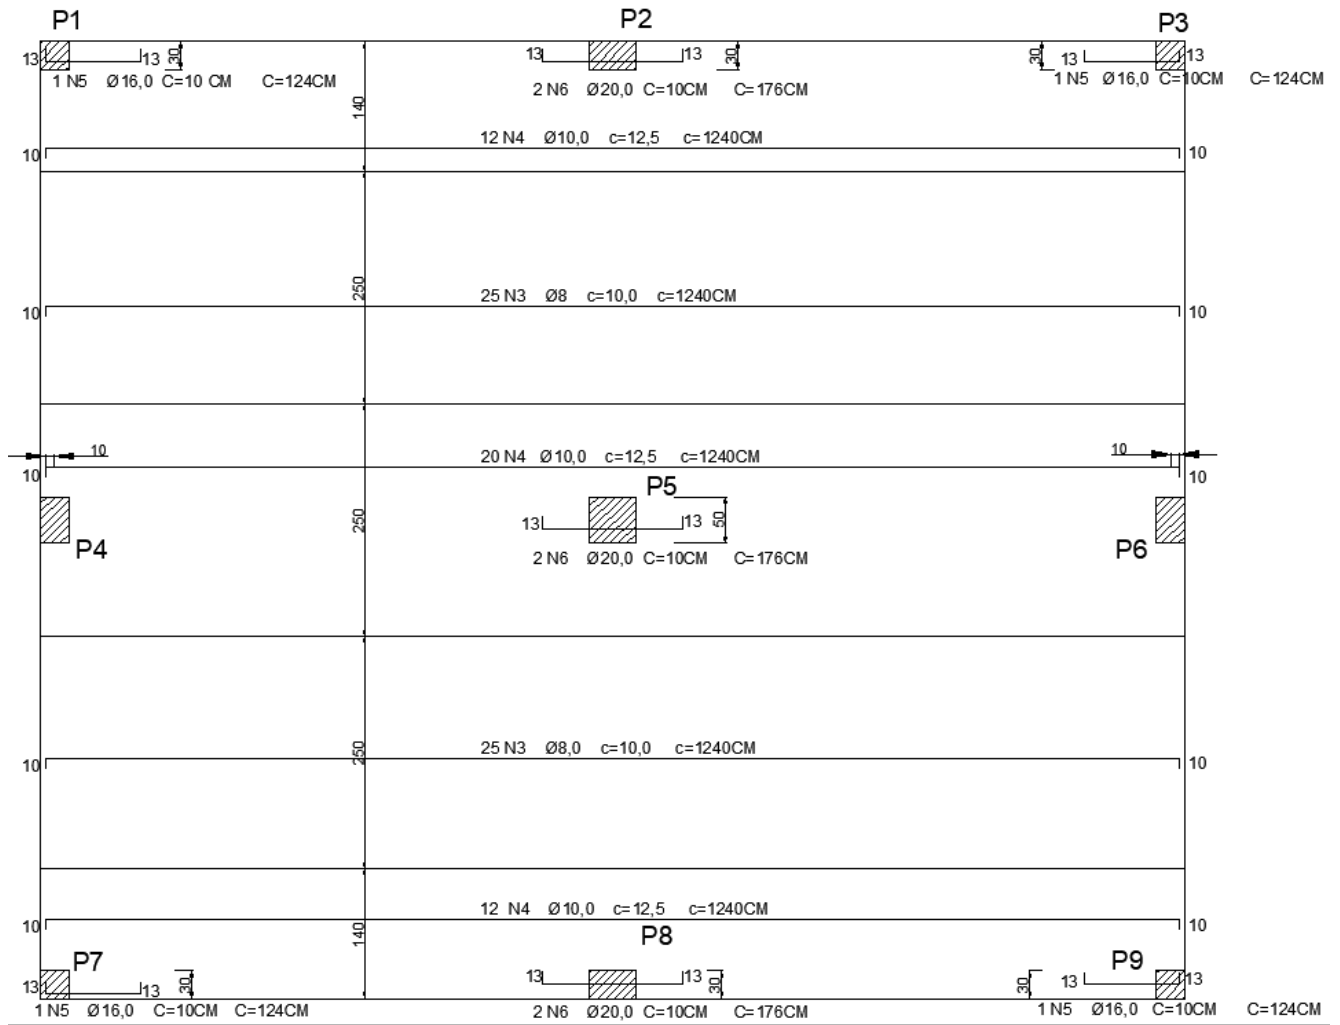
Armaduras inferiores na direção X pela NBR 6118/2014
